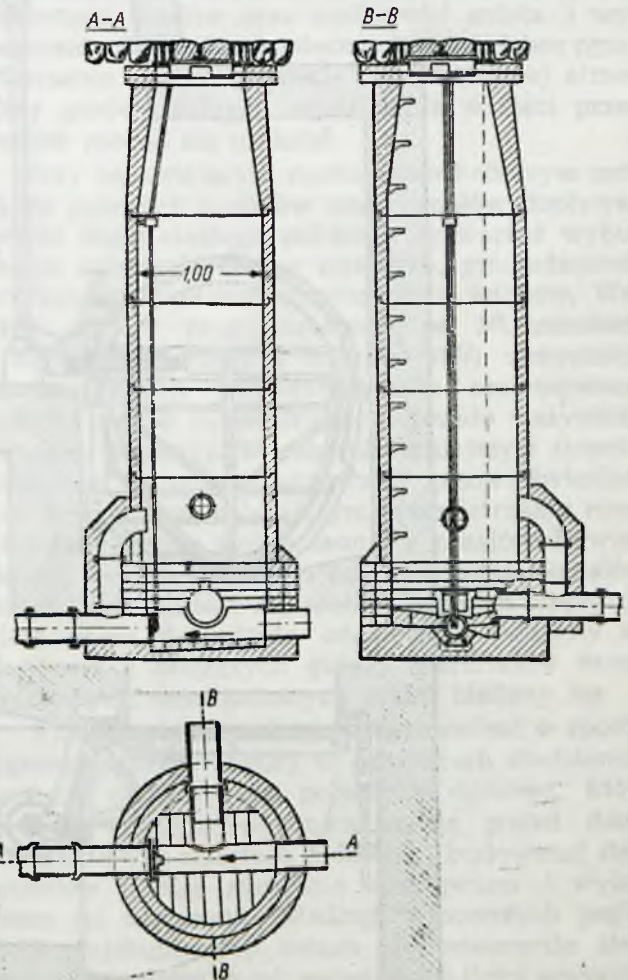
Zasuwa kanałowa poruszana silnikiem elektrycznym
